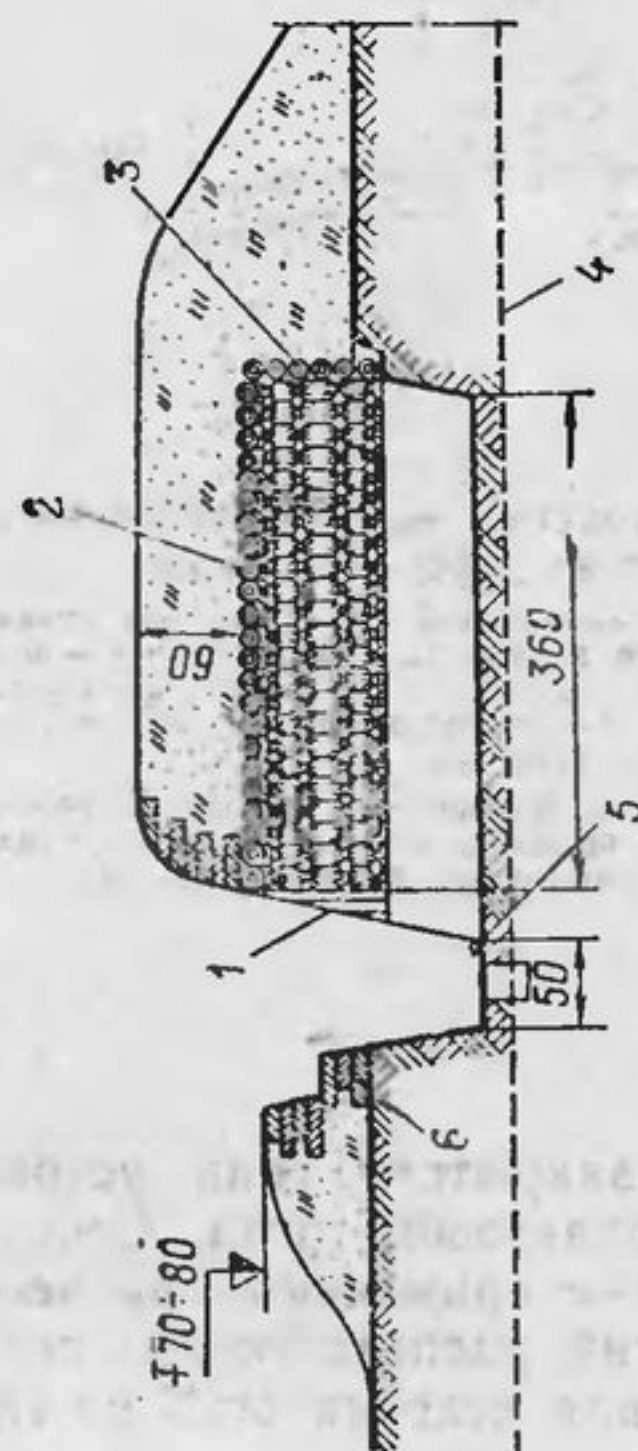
Перекрытая щель с перекрытием из криволинейных фашин:
